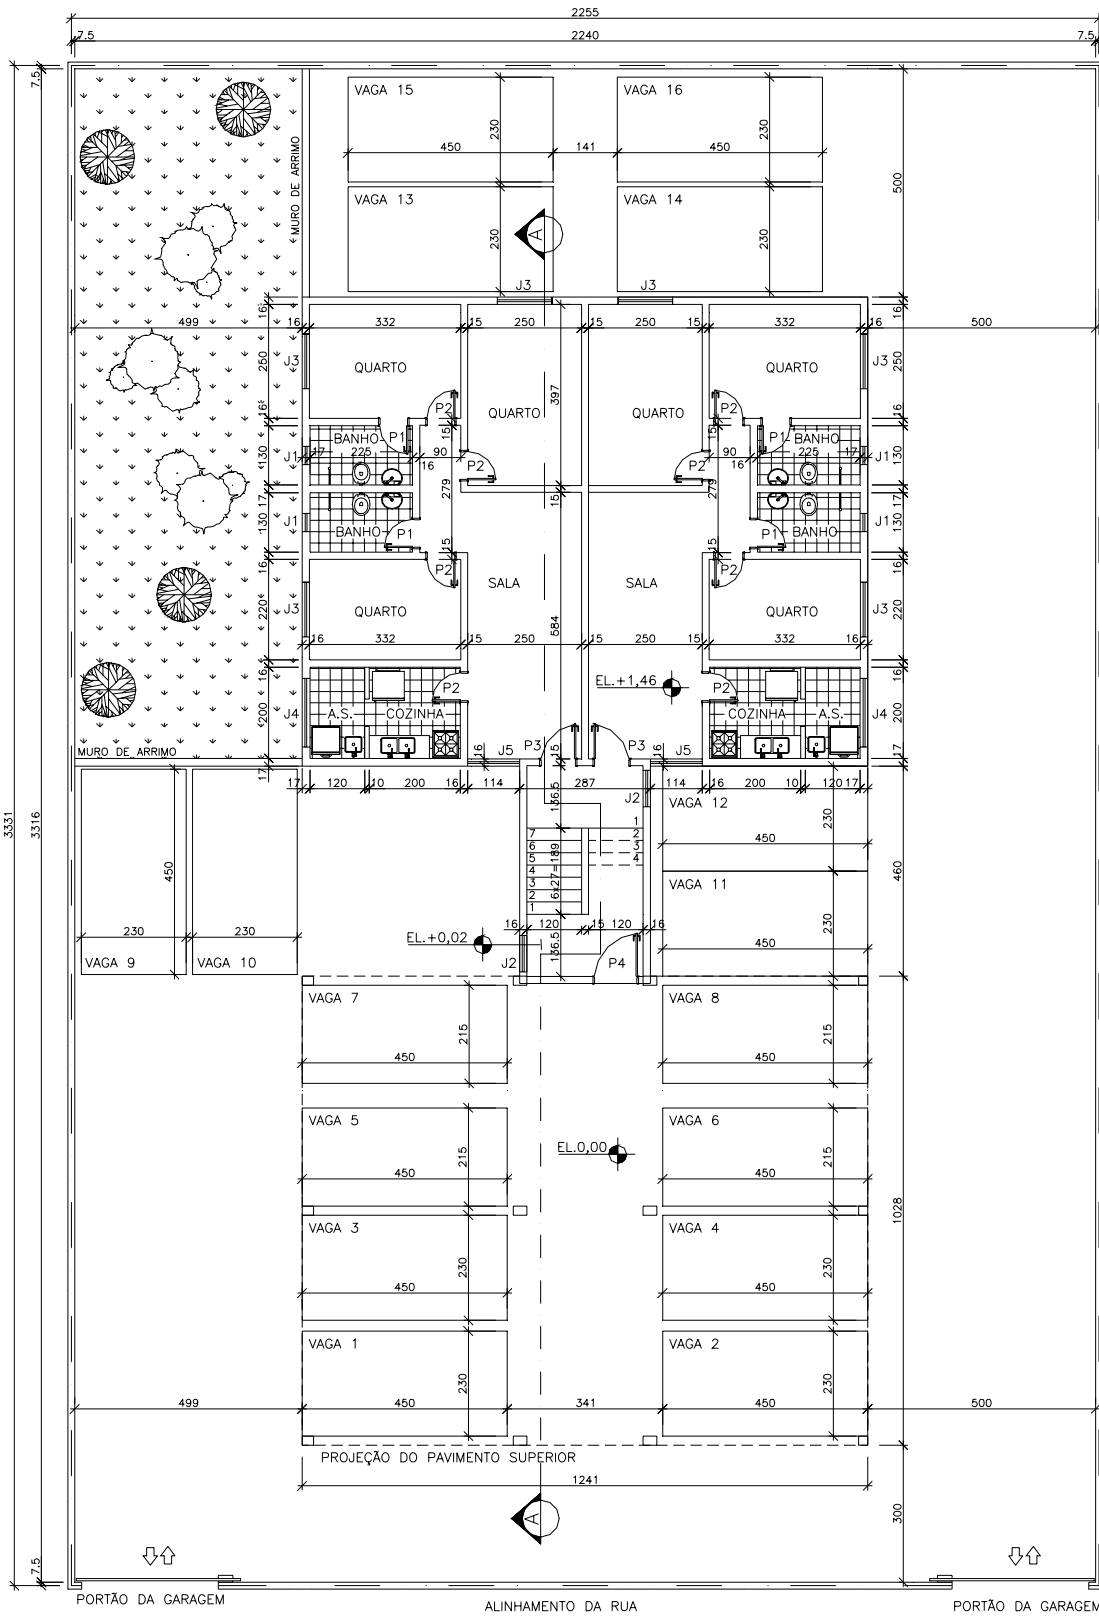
Prédio “C” – Opção 3 – Planta da Garagem
